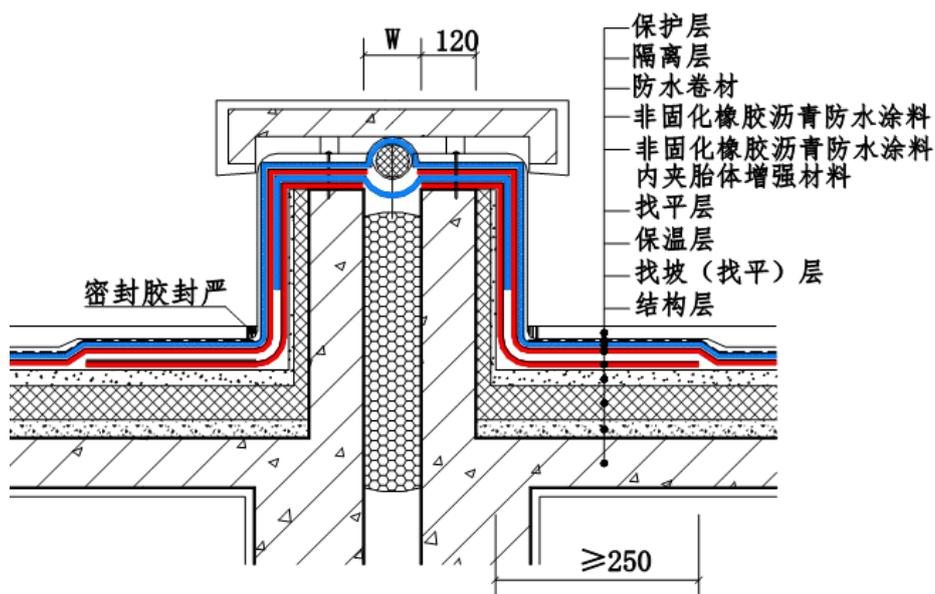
正正式混凝土盖板等高变形缝防水构造
